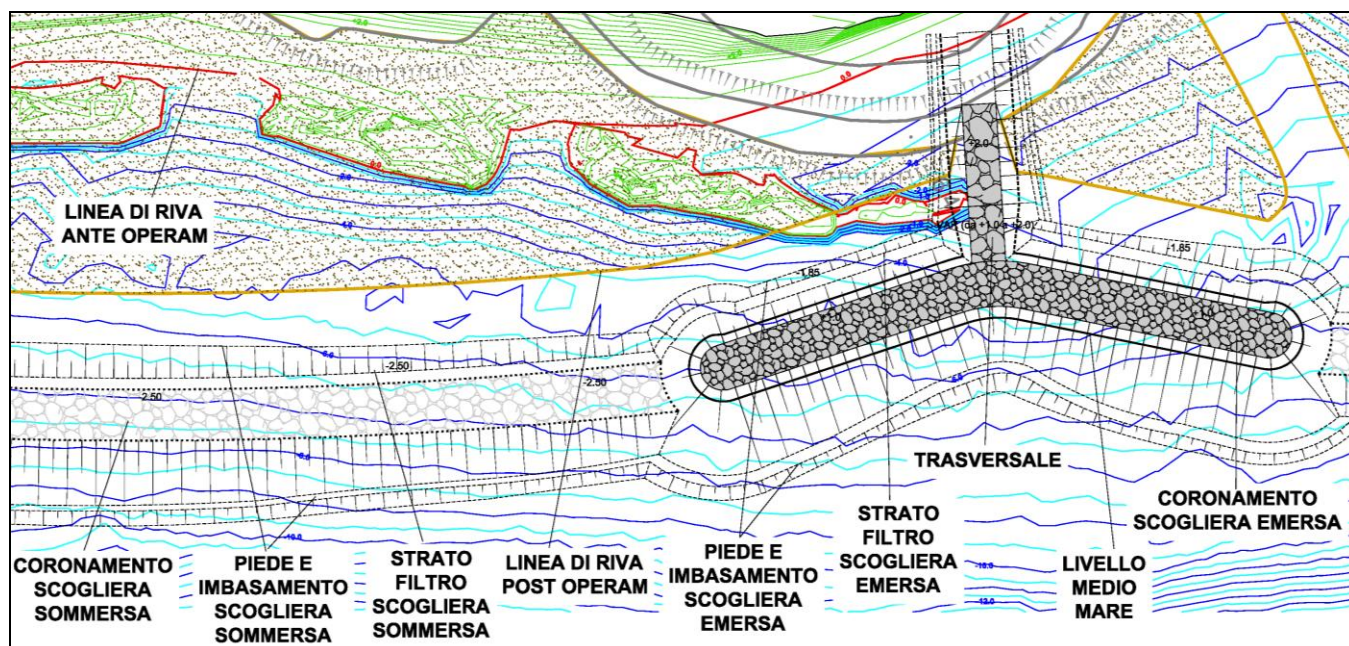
Dettaglio planimetria di progetto del ripascimento protetto a Nord del porto esistente
